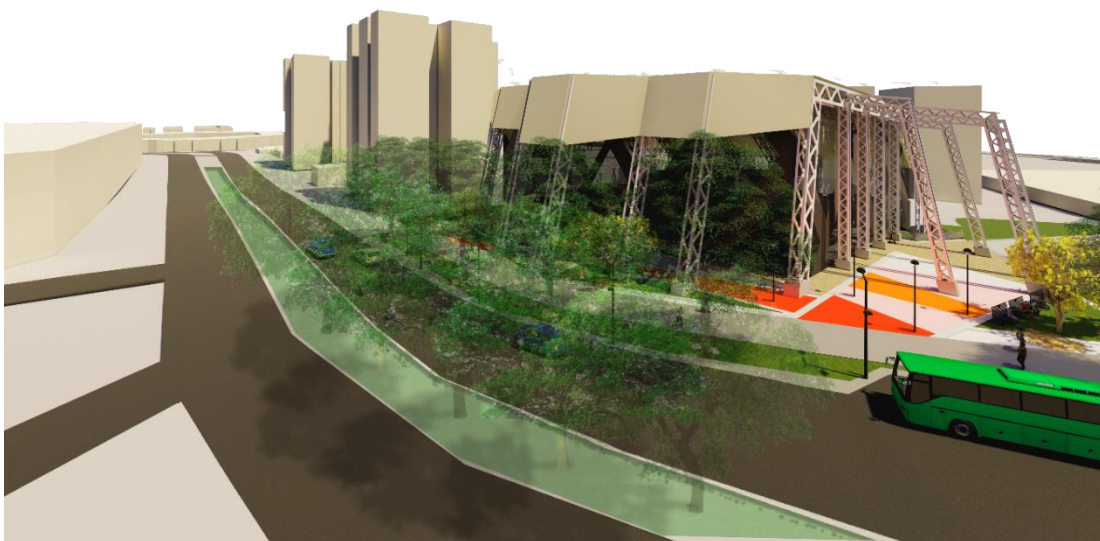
Renderizado vista desde la calle 56 (norte-sur). Elaboración propia
